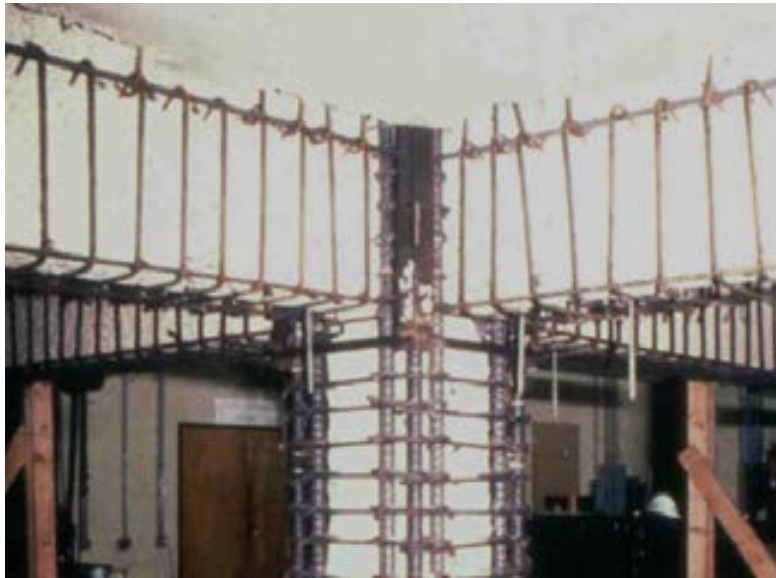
Encamisado de nudo, de columna y de viga (Alcocer y Jirsa, 1991)
